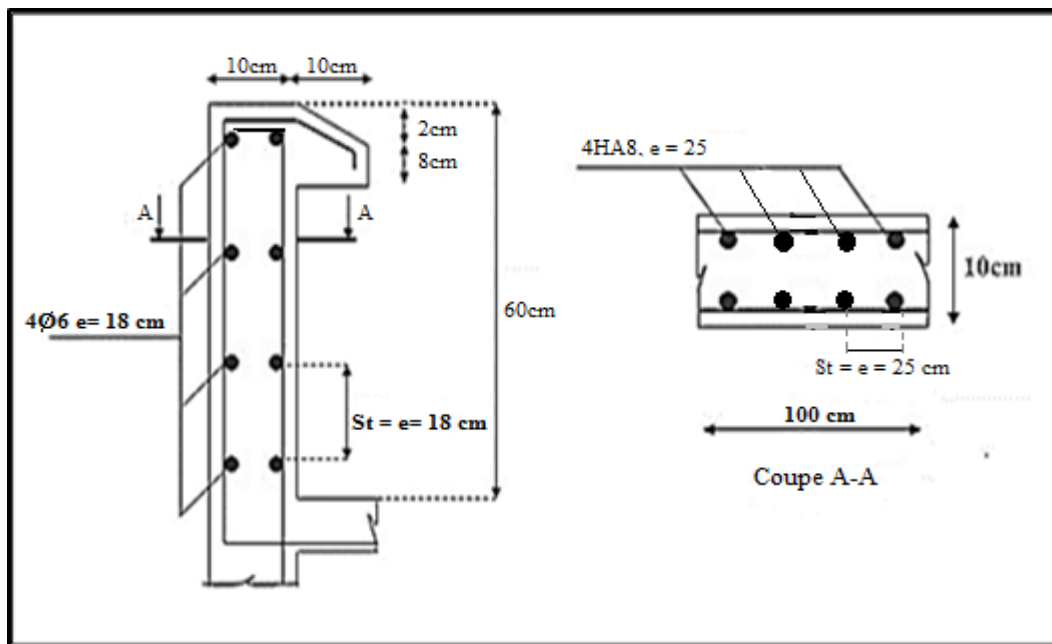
Schéma de ferrailage d'acrotère.
